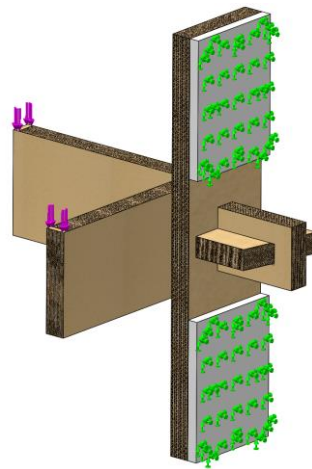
Configuración ensayo de carga estática sobre unión B-HHV || Fuente: Elaboración propia
